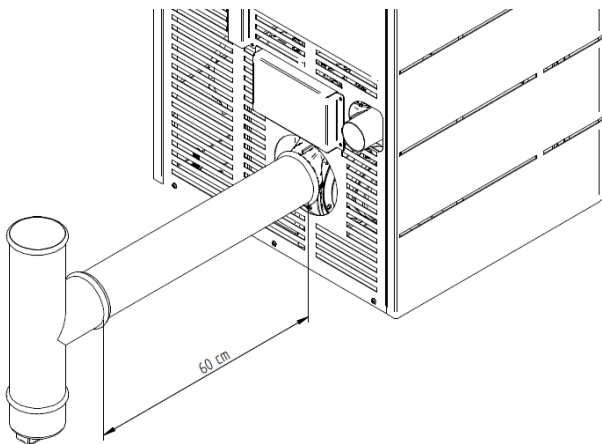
Instalação de um t de inspeção com uma peça de aumento
